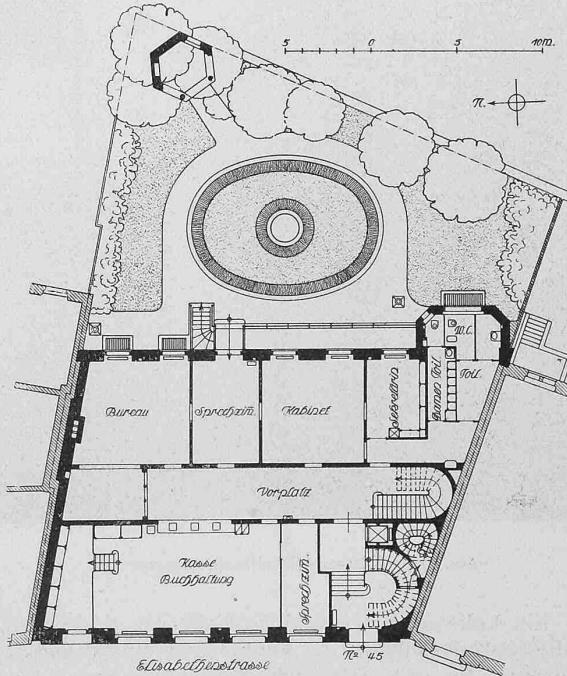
bis 3. Grundrisse vom Erdgeschoss, I. u. III. Stock. — 1:400.
